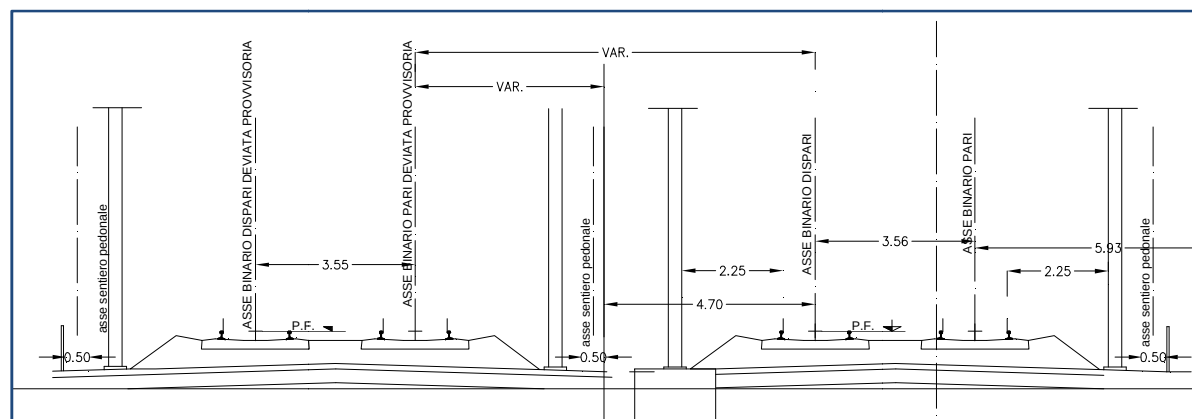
Soluzione 1 – Sezione trasversale fase 1
